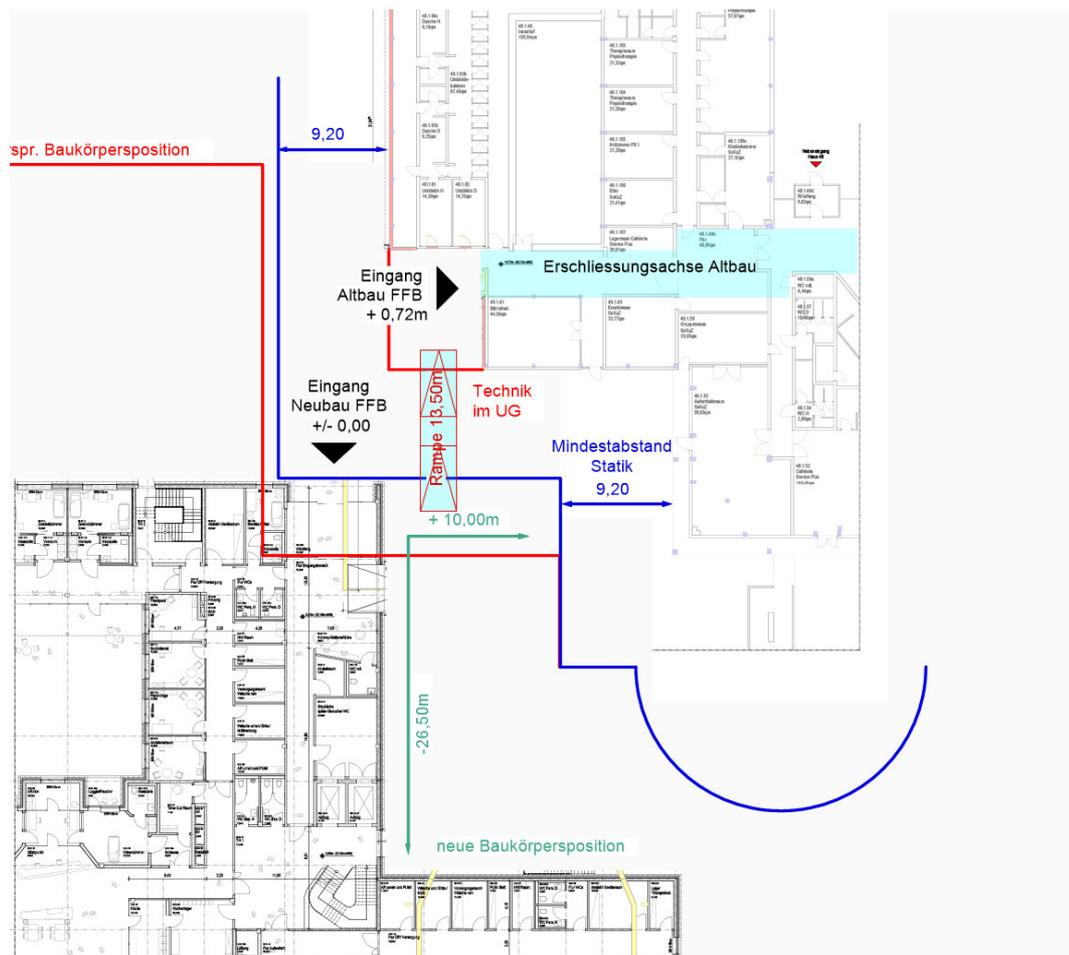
\_ Grundrisslupe verschobener Baukörper
